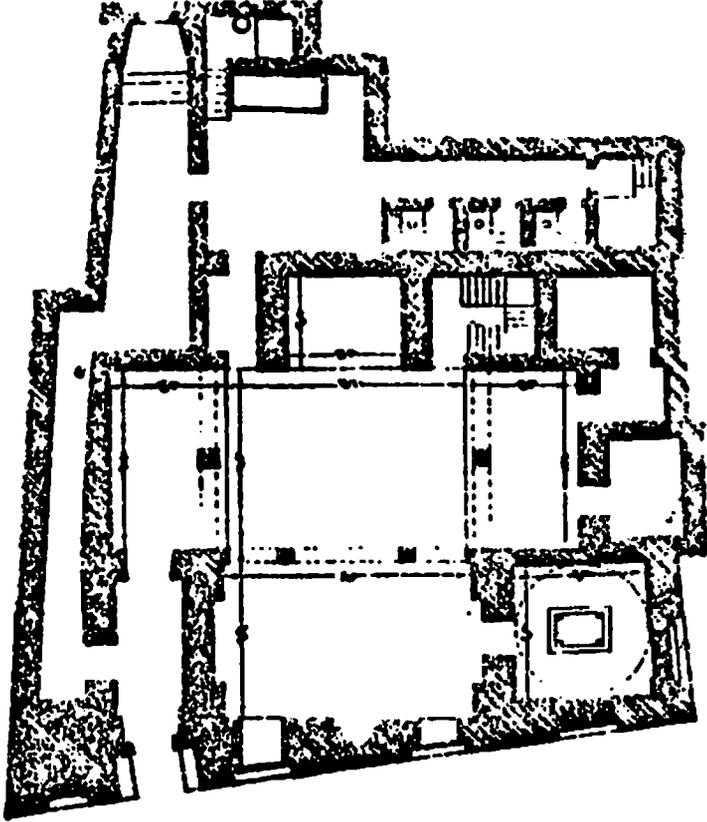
مسقط أفقى لقبىتى سلاار و سنجر بشارع ماراسينا بالسيدة زينب
